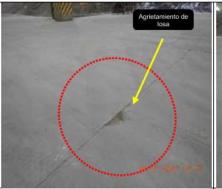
Vista fotográfica de la fisura ubicada en el área 11 del almacén de zinc y cobre en la coordenada WGS 84 zona 18: 8667922N, 268182E 47.
